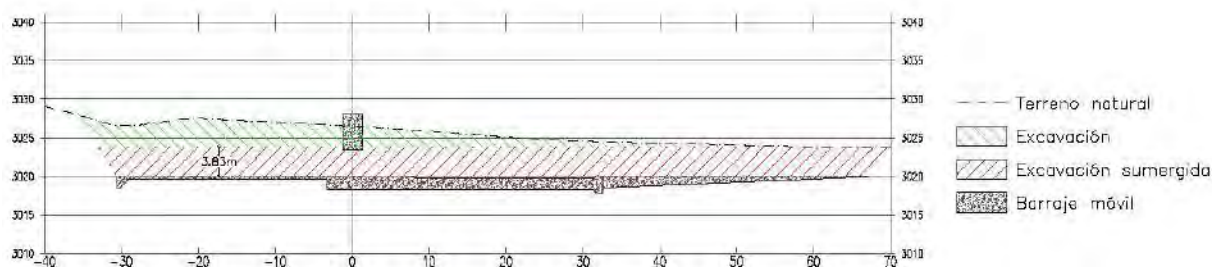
Sección típica de excavación en barraje móvil. Fuente: Elaboración propia.
